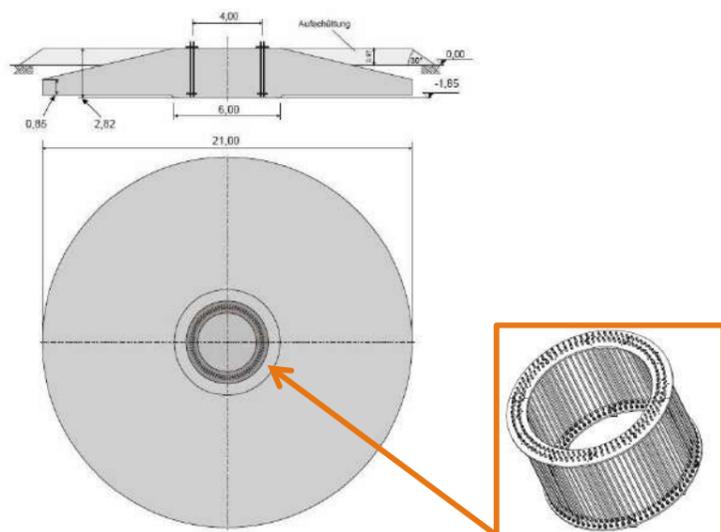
Schéma indicatif d'une fondation type et de sa cage d'ancrage
